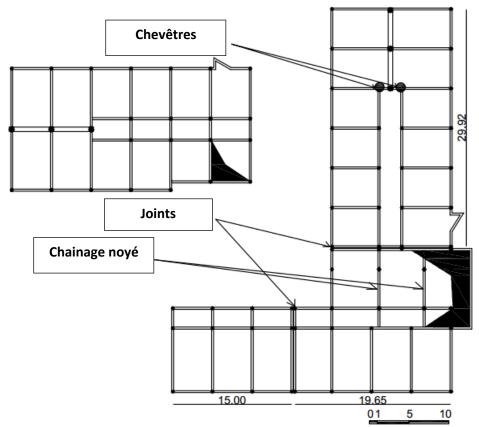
plan de structure exemplaire de bloc A+B. Source : Auteurs.
